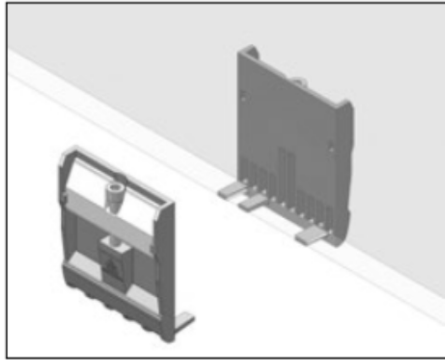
Installation de garde-corps rampant (cf. détail b Figures 22 et 23 pour l'installation en rampant avec cale)
